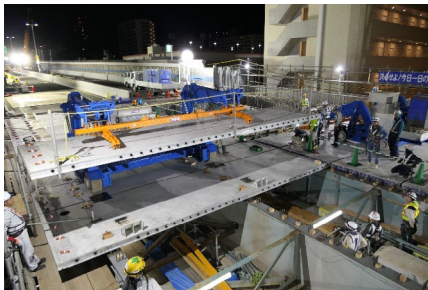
④ 専用機械によるプレキャストコンクリート床版の設置状況
